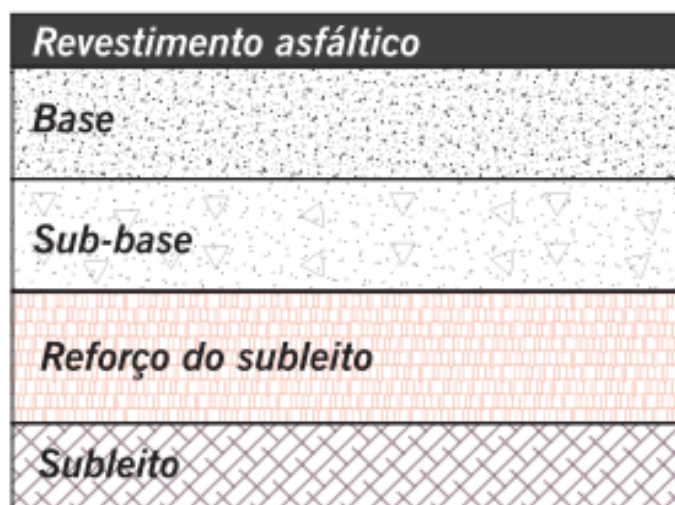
Estrutura do pavimento flexível (Bernucci et al., 2010)
